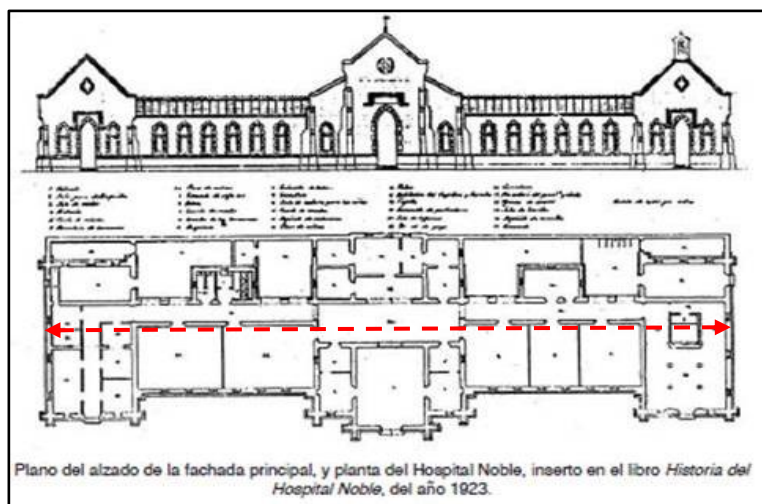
Plano del alzado de la fachada principal del Hospital Noble
